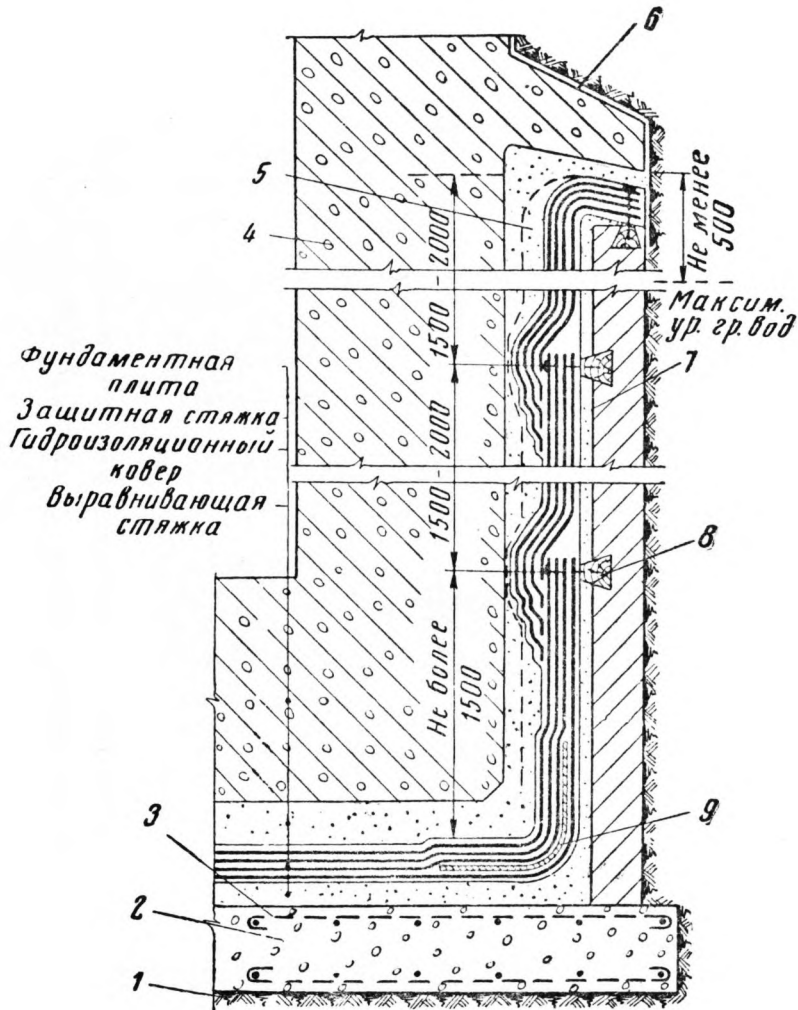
Крепление гидроизоляционного ковра, наклеиваемого на защитные стенки
